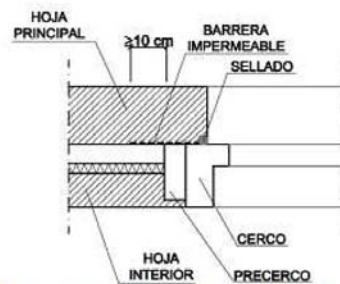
Ejemplo de encuentro de la fachada con la carpintería
